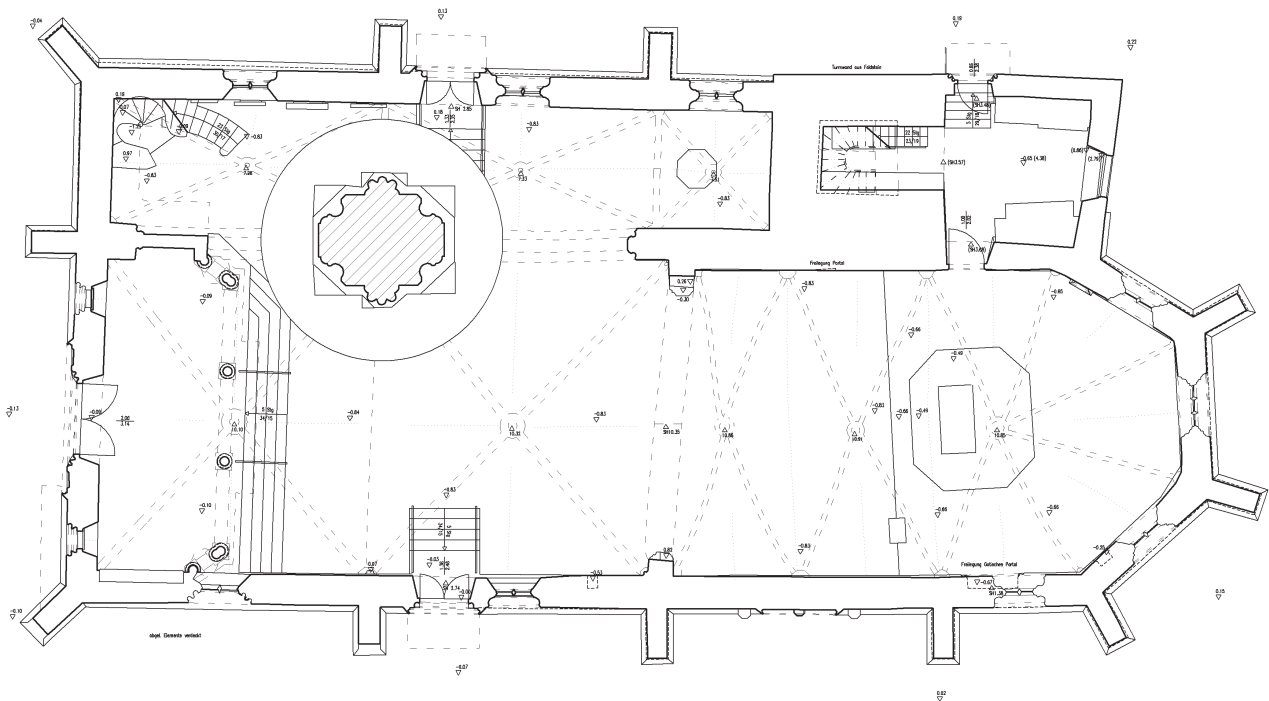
Grundriß der Pfarrkirche im Originalmaßstab 1:50, Detailausschnitt M 1:5
